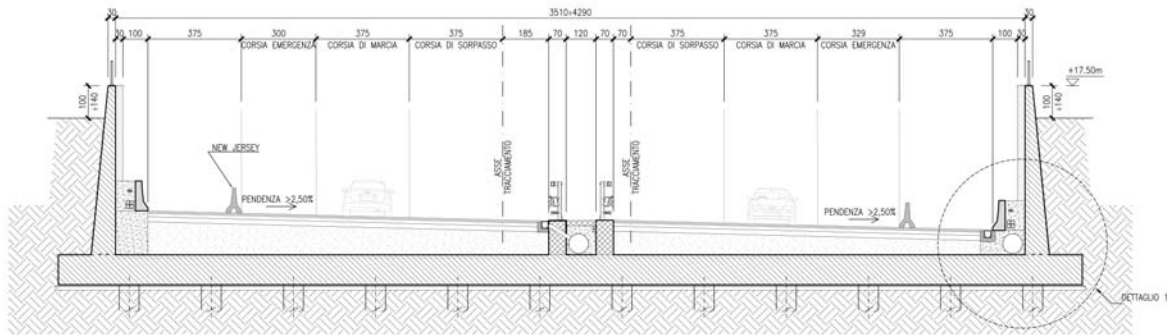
SEZIONE TIPICA TRINCEA 3.
